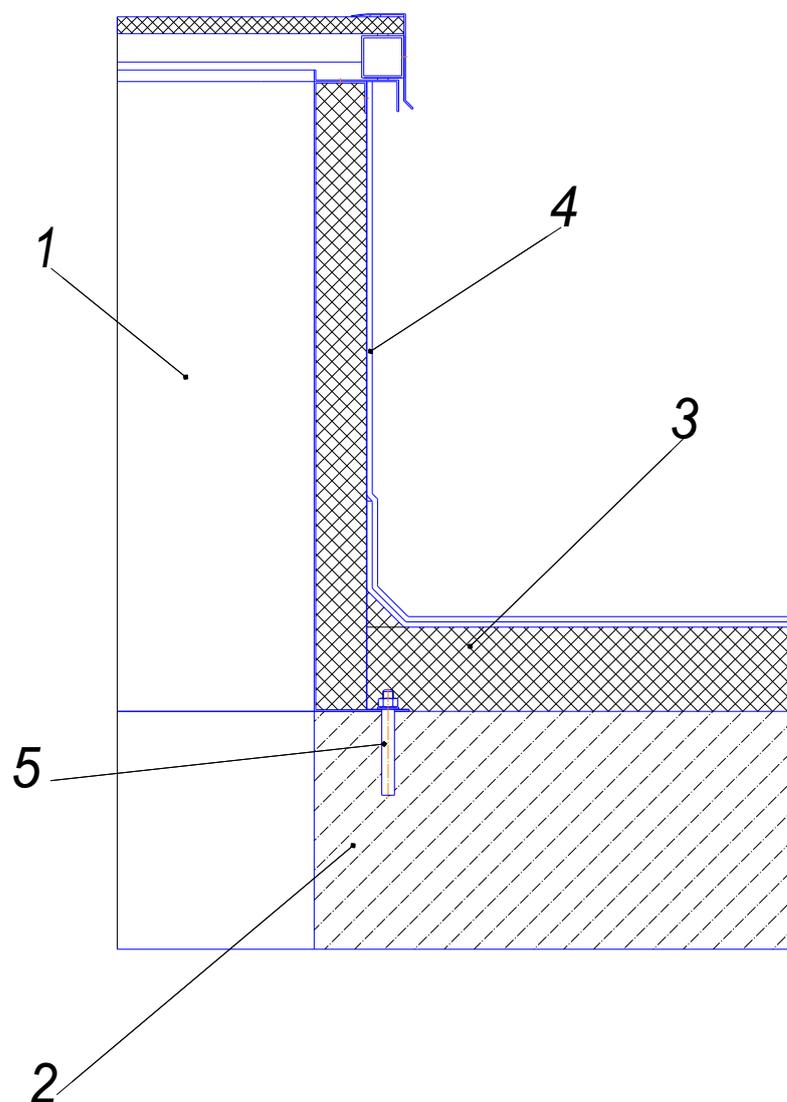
Рекомендуемая схема монтажа кровельного люка дымоудаления на капитальных кровлях
